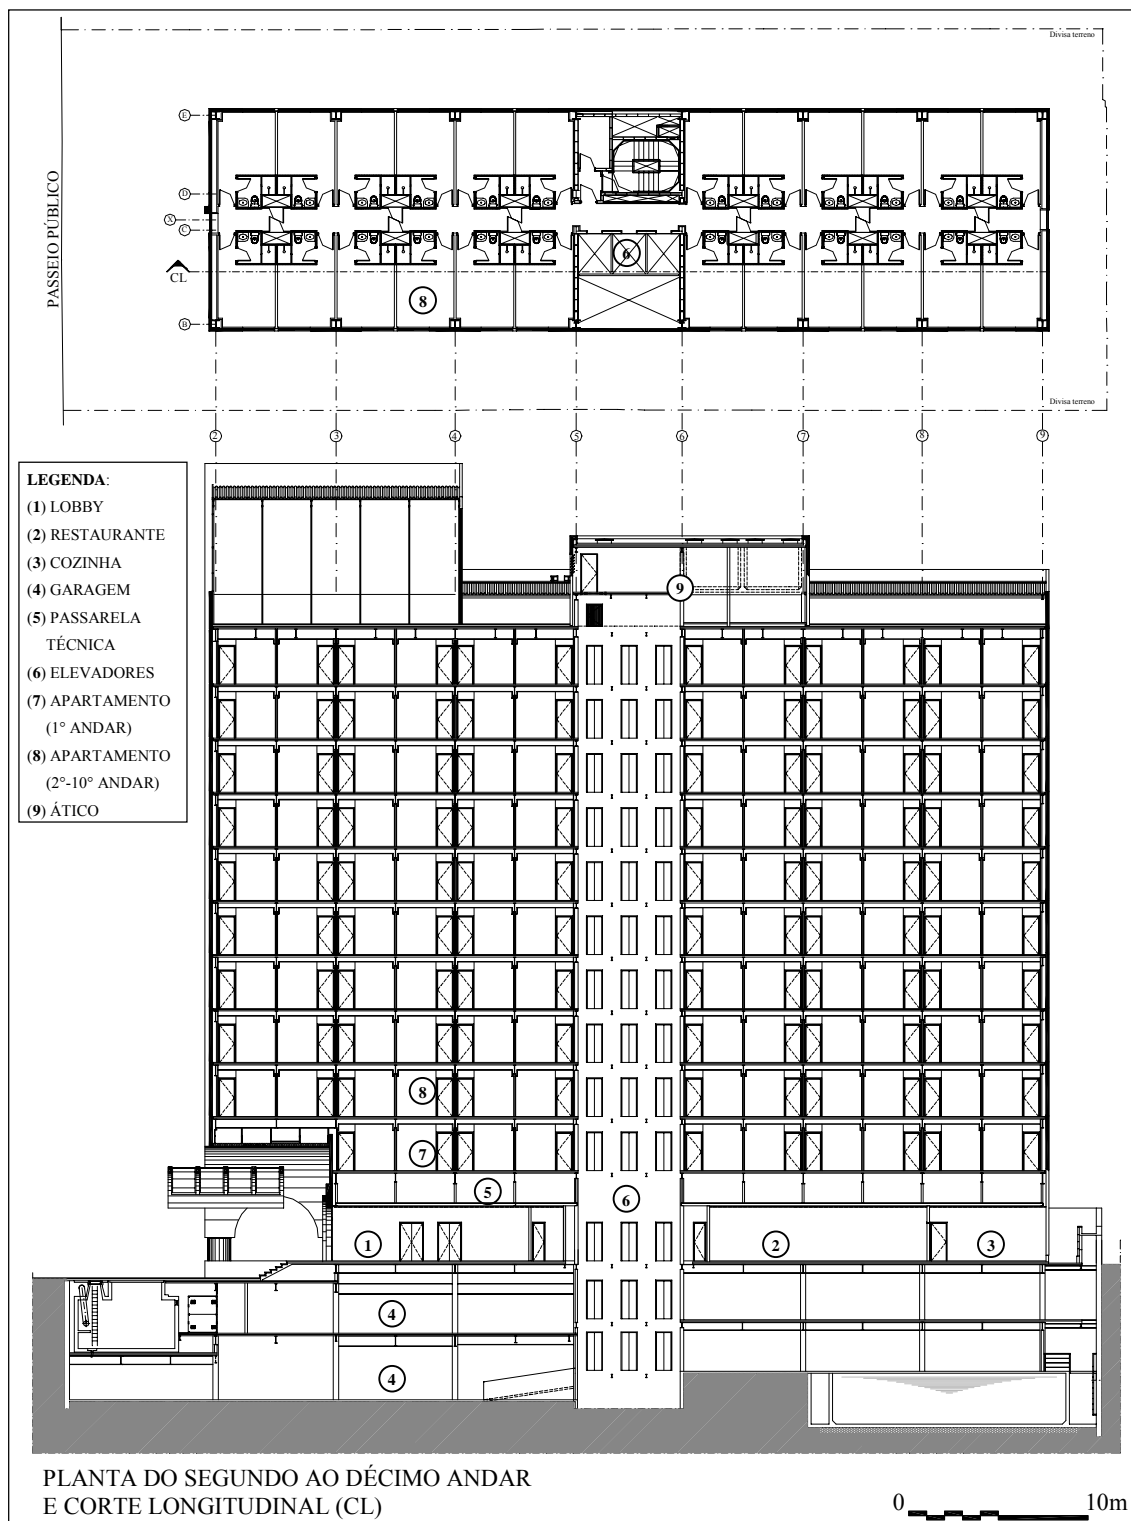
Solução arquitetônica do edifício E-3: esboço da planta dos pavimentos-tipo (2º ao 10º) e respectivo corte longitudinal.
